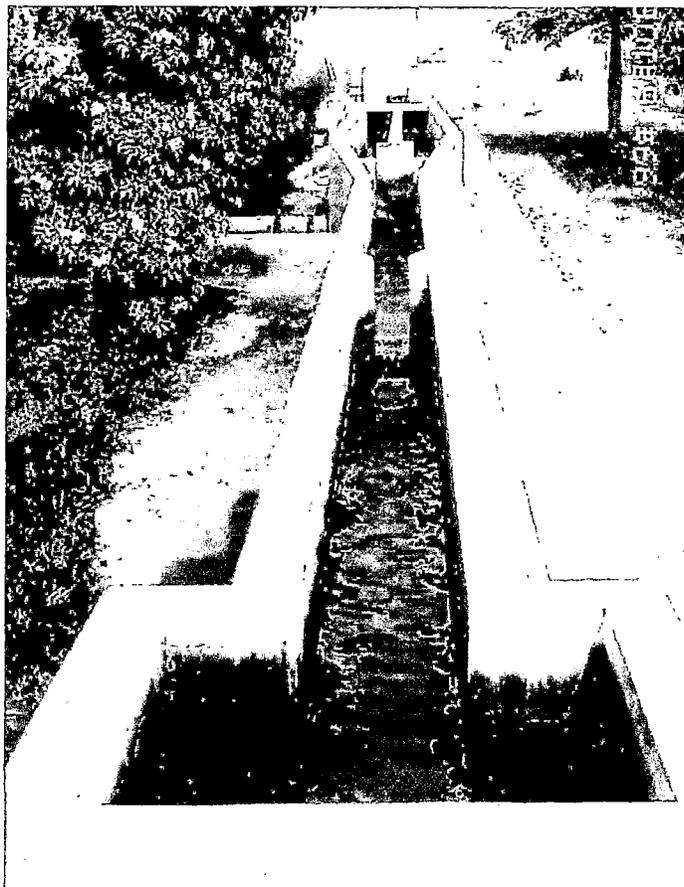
Medidor Palmer Brown, que mide el caudal que ingresa a la planta.
